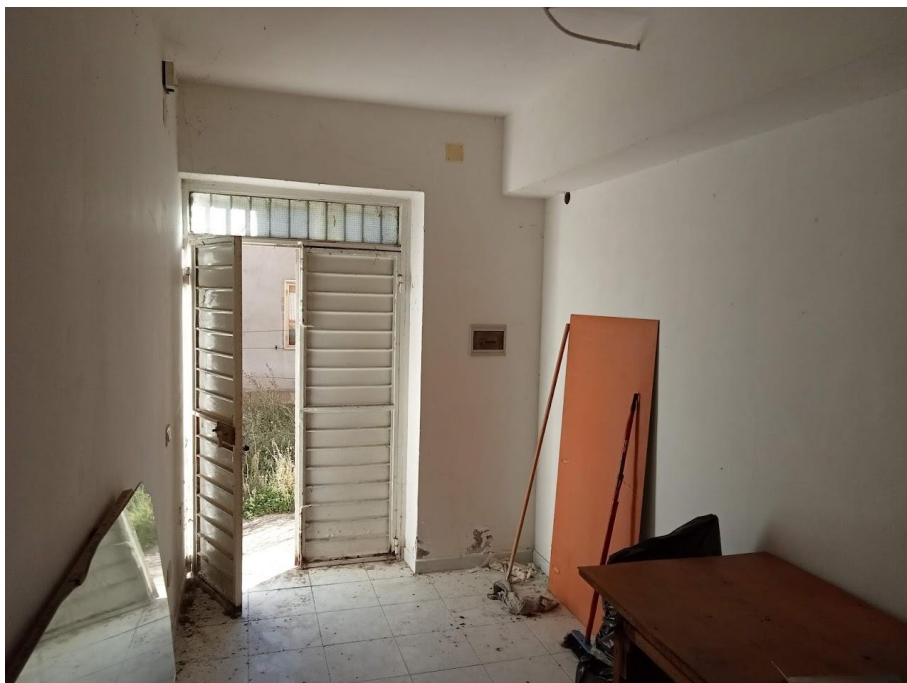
di 17 LOTTO n° 8 – Magazzino
